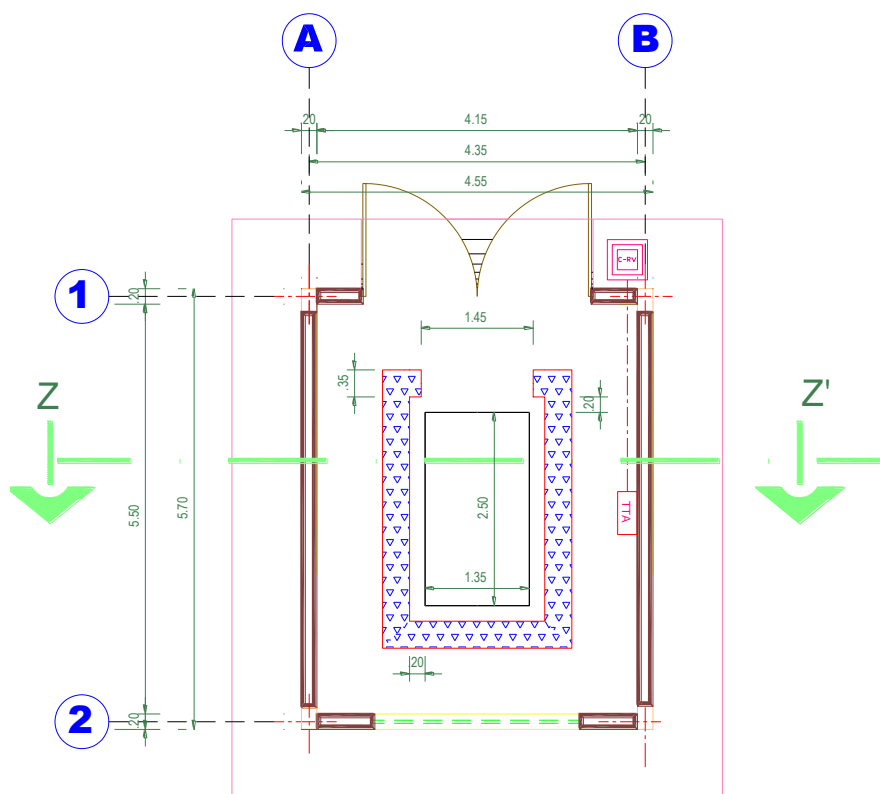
Planta arquitectónica local del generador de 250KVA
